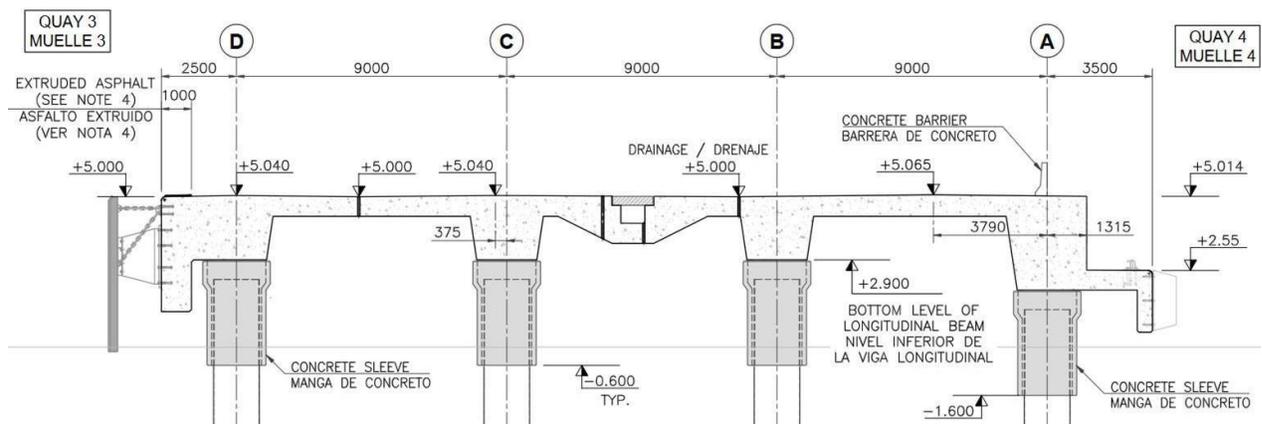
Sección transversal de Q3/Q4. Fuente: Cotema.
